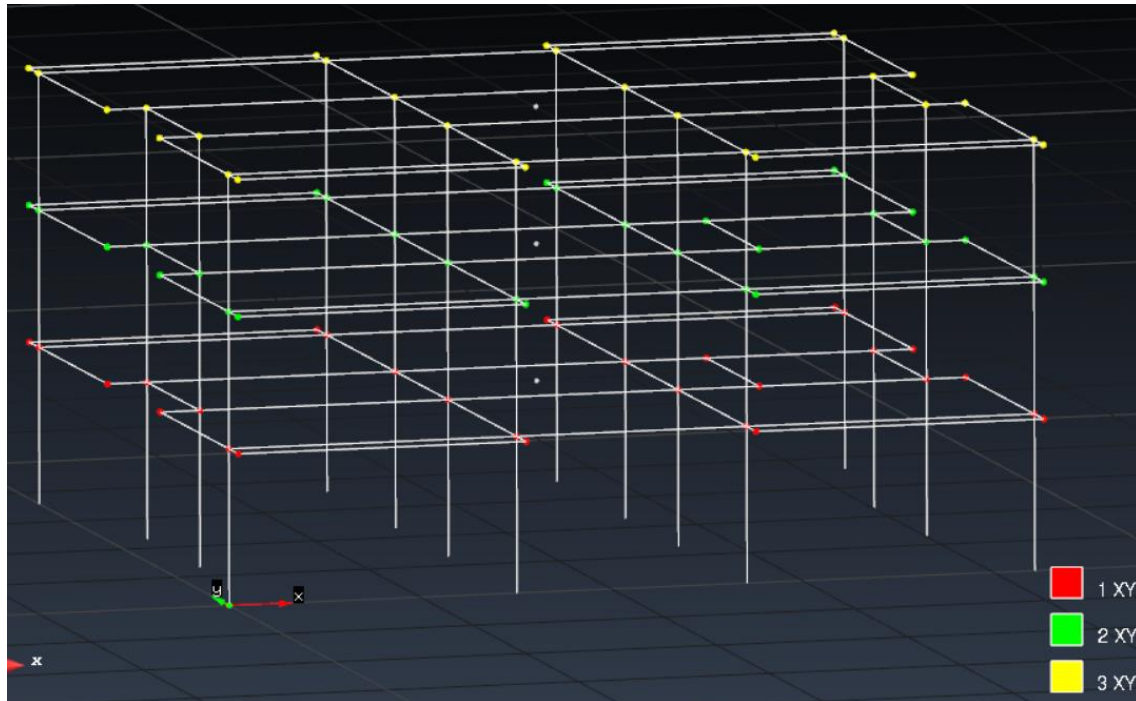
Identificación de los nodos esclavos de cada forjado de la estructura. Rojo: Forjado de planta primera. Verde: Forjado de planta segunda. Amarillo: Forjado de cubierta. (Fuente: GiD)
